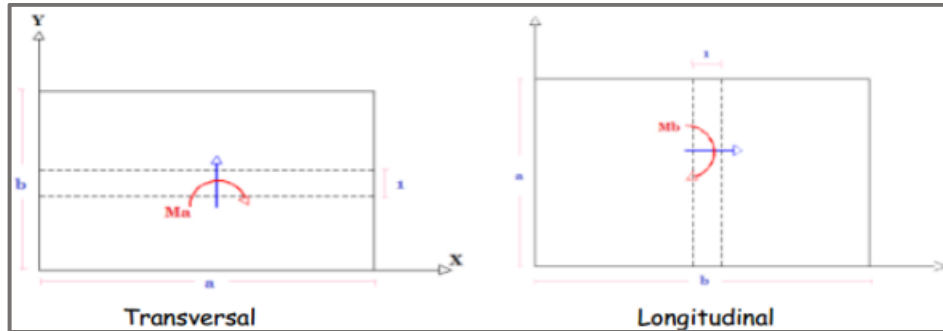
Moments Transversal et Longitudinal sur la dalle centrale.
